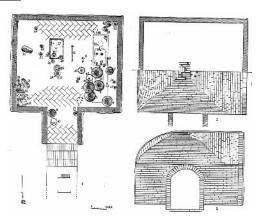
4 甲 1027 号墓 1、墓室平面図 2、墓室俯視図 3、墓室前側展開図
